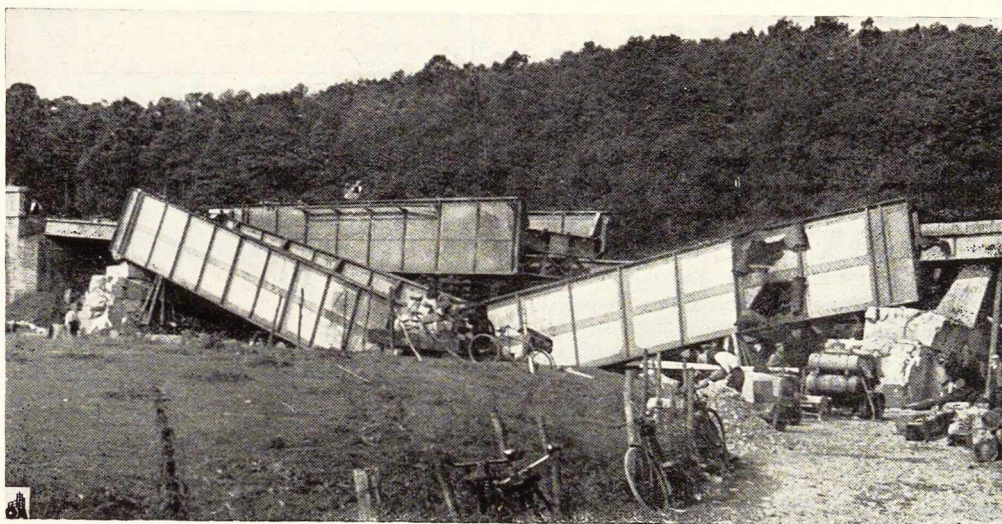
Pont de Melreux sur la ligne Liège-Jemelle. On note que la plus grande partie de l'ouvrage est encore réutilisable, les destructions étant localisées. Voir également la figure 184.
